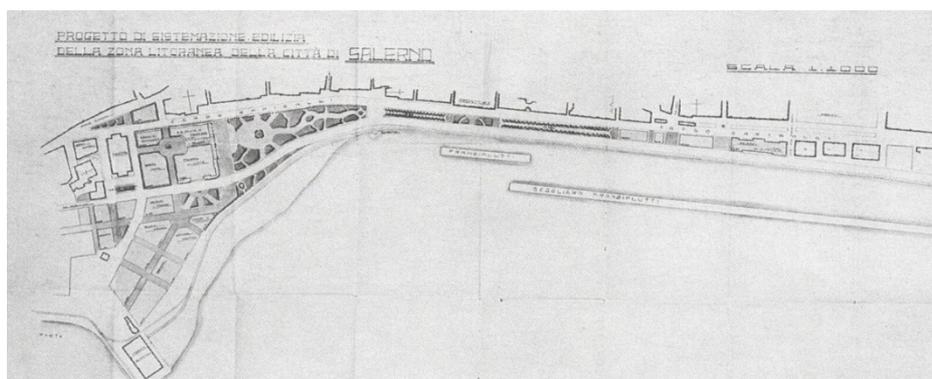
Progetto di sistemazione edilizia della zona litoranea*, planimetria scala 1:1000, Ing. Luigi Centola 1912
